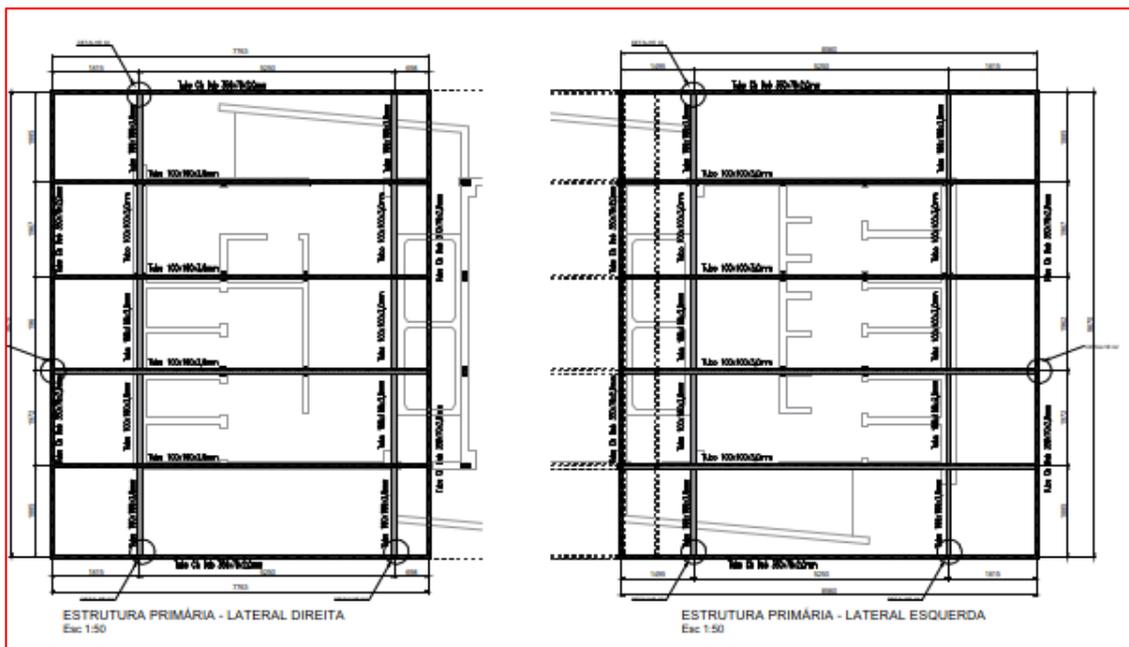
Projeto Estrutural da Cobertura - Fonte: CEASA/PR e FUNDAMENTO ENGENHARIA
